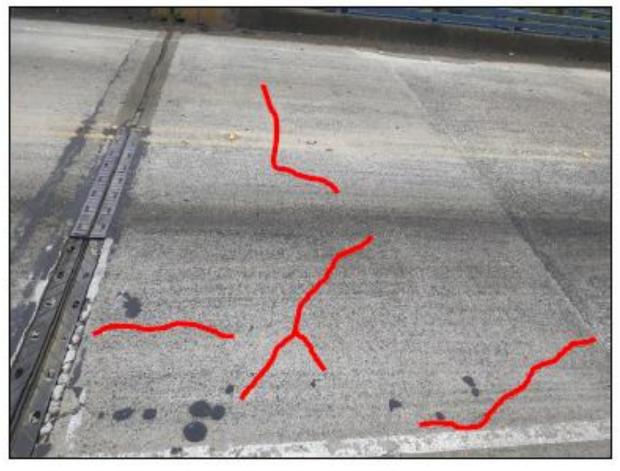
Fisuras en red en la losa de concreto del Puente Salitral
